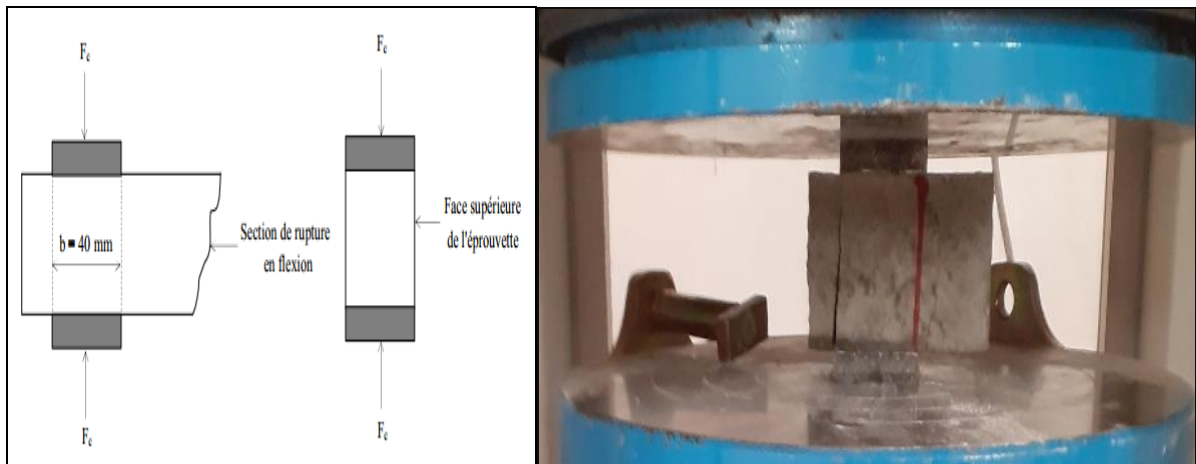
Essai de compression sur les éprouvettes (4x4x16) cm³
